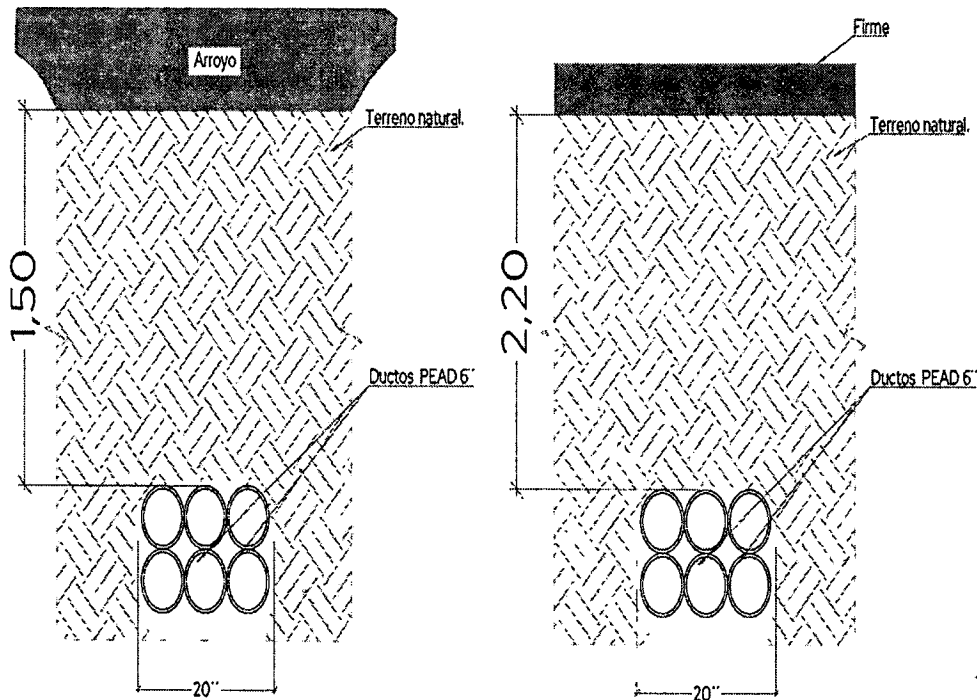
e Imagen 8. Detalle distancia entre el lecho del canal y la cota máxima de la tubería a instalar. - Fuente: RODAS SOLAR S.A.S, 2025
